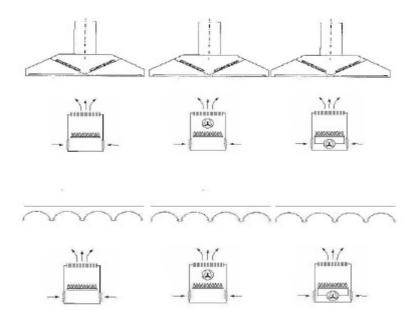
Installazione di apparecchi di tipo A1/ A2/ A3 sotto un sistema di aspirazione con ventilazione naturale
